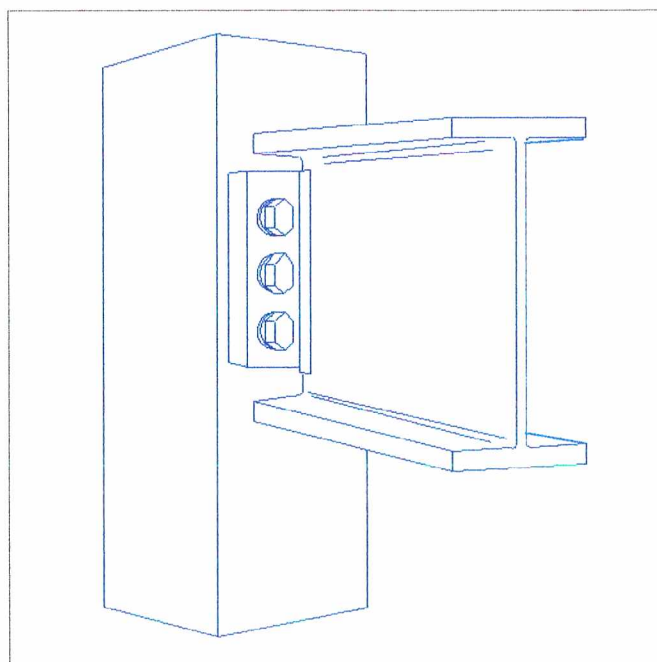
Estrutura metálica fixada com buchas roscaadas [11].
